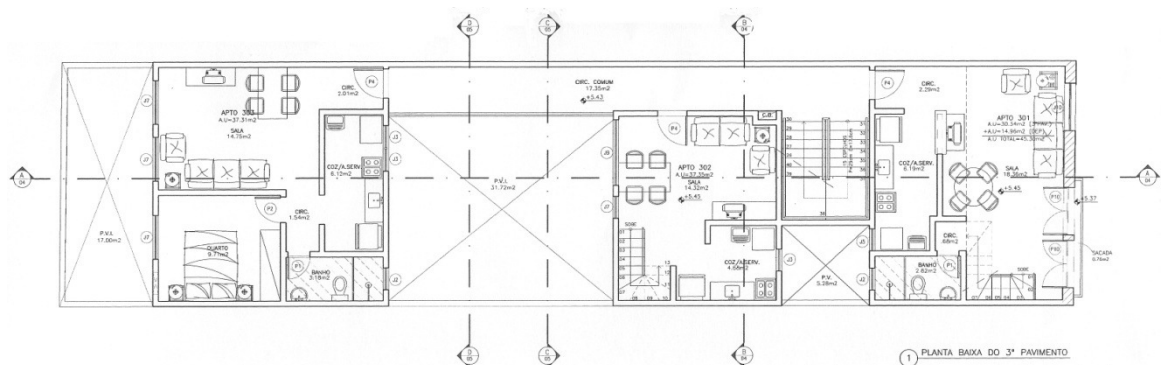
Planta de layout do 3º pavimento do empreendimento João Álvares 18.
